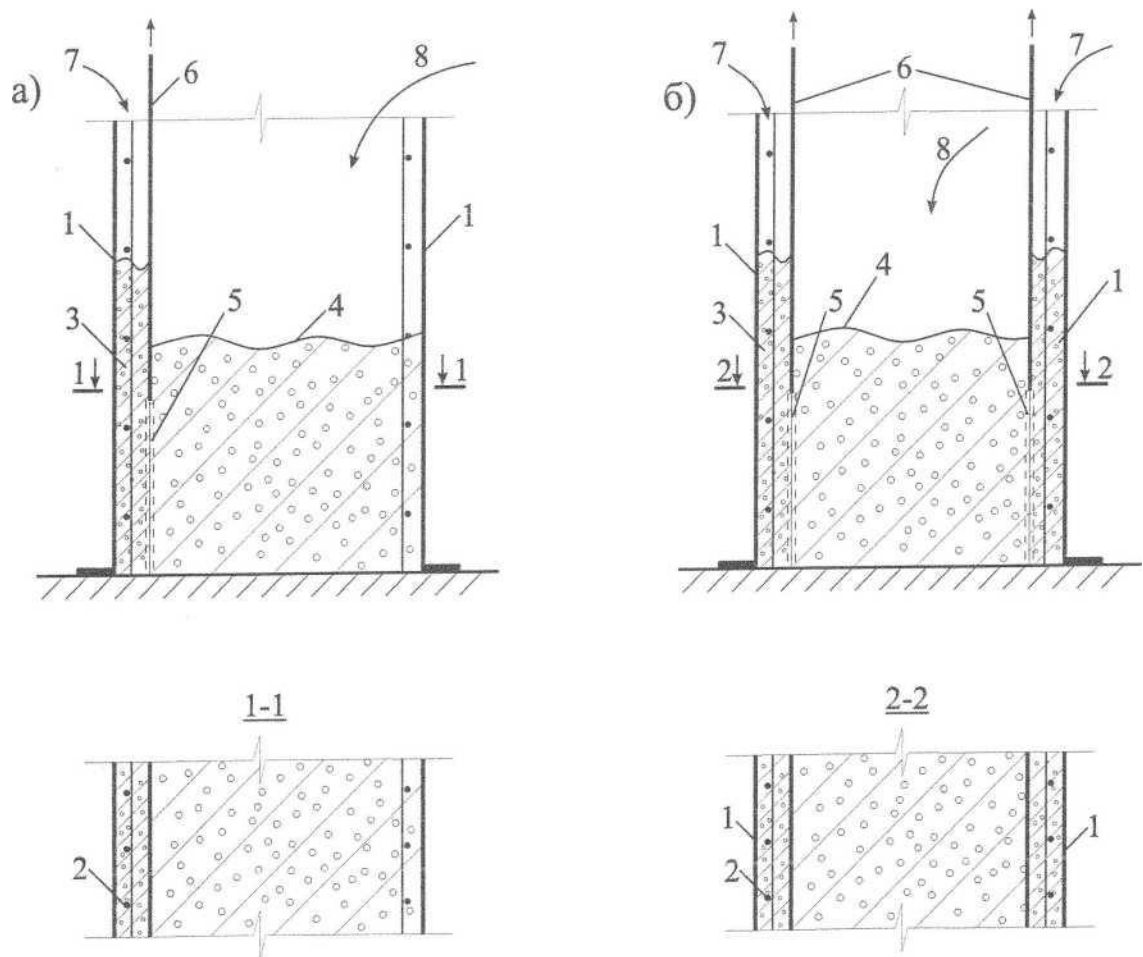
Схема бетонування зовнішніх несучих залізобетонних стін
